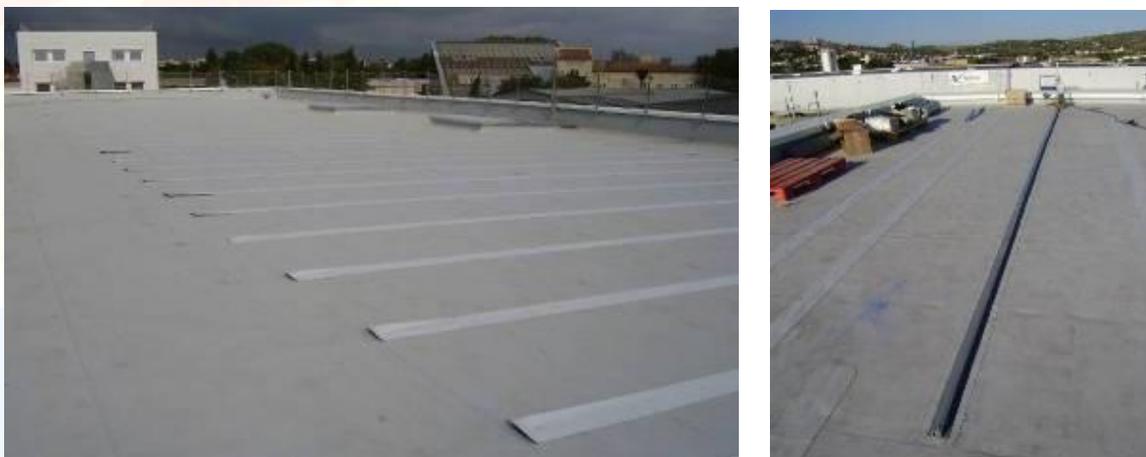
Installation du profilé RENOLIT ALKORPLUS 81600 et son insert le long des joints longitudinaux d'une membrane RENOLIT ALKORPLAN F
